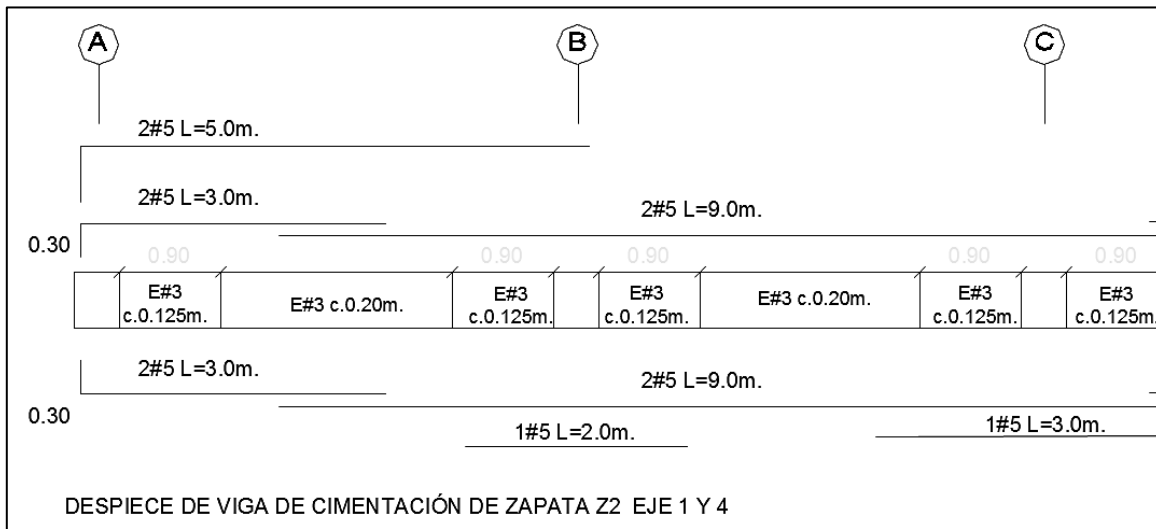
Figura X Despiece de viga de cimentación de zapata Z2 eje 1 y 4.
